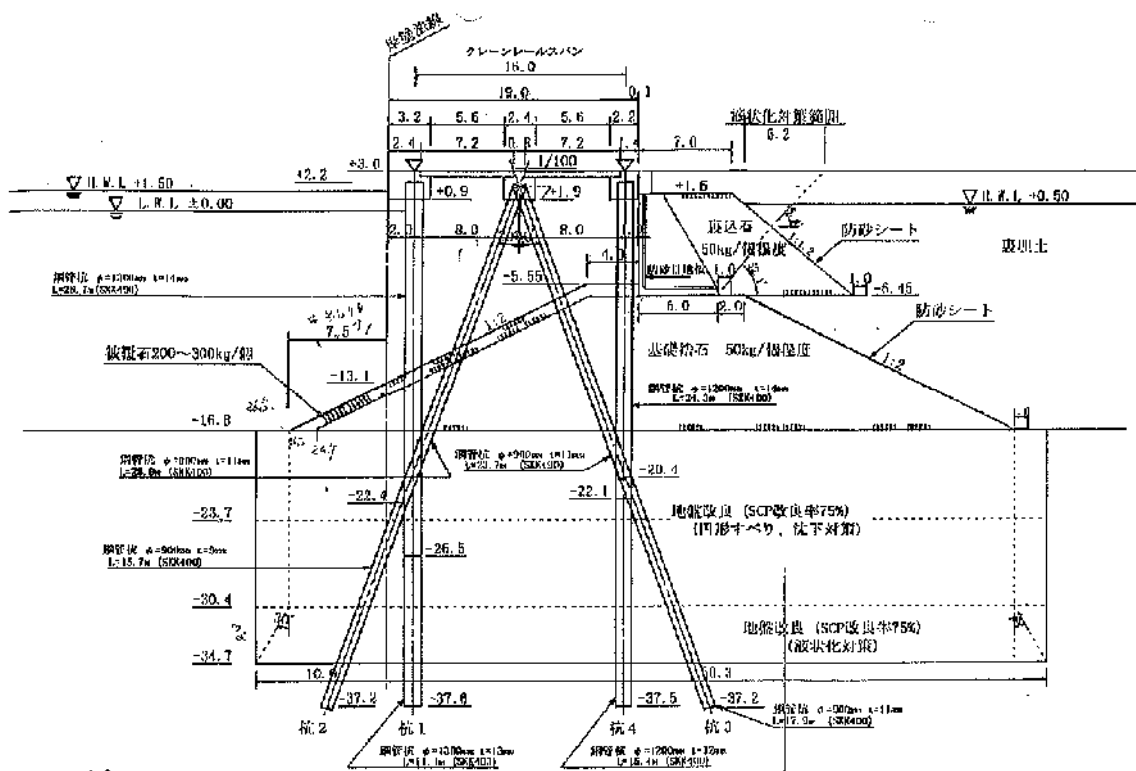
永浜地区栈橋 (-13m) の標準断面図
